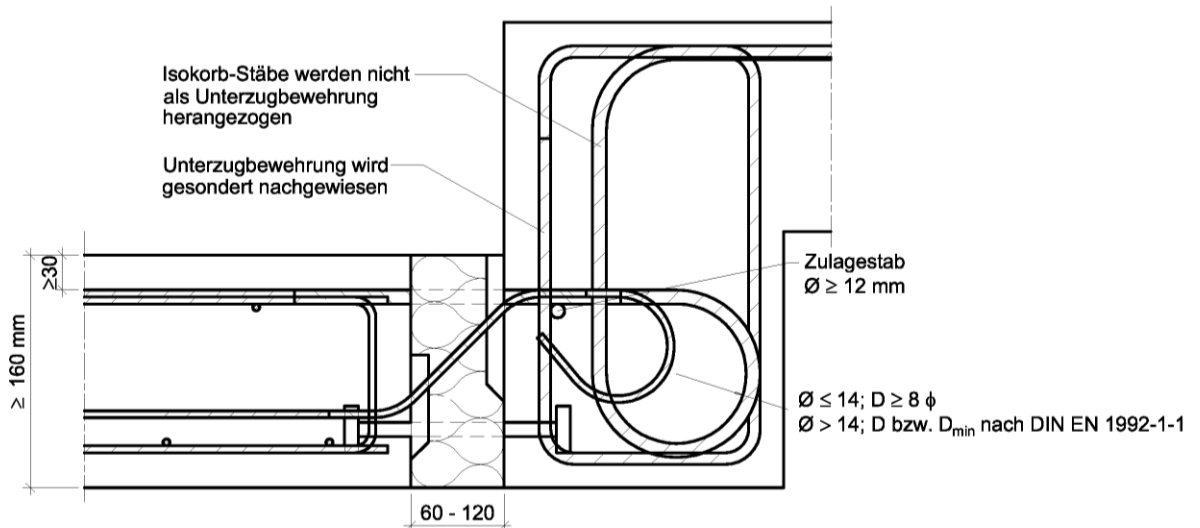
Beispiel Schöck Isokorb® Typ KX (Variante Höhenversatz) mit Vertikalbewehrung (balkonseitig)
